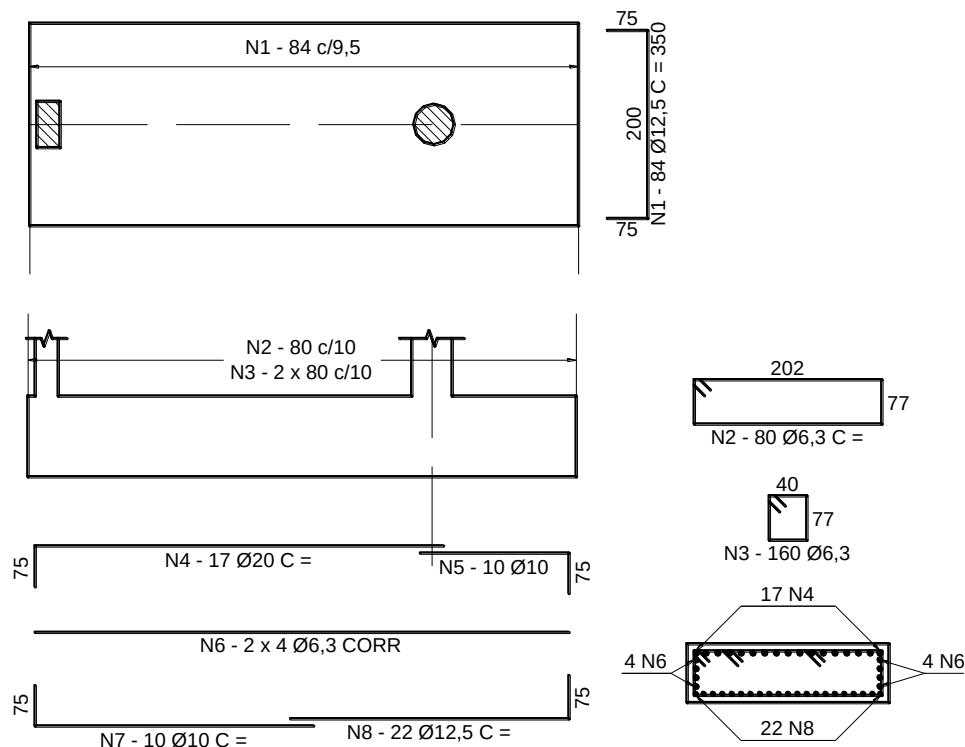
Esquema do detalhamento das armaduras da sapata.
